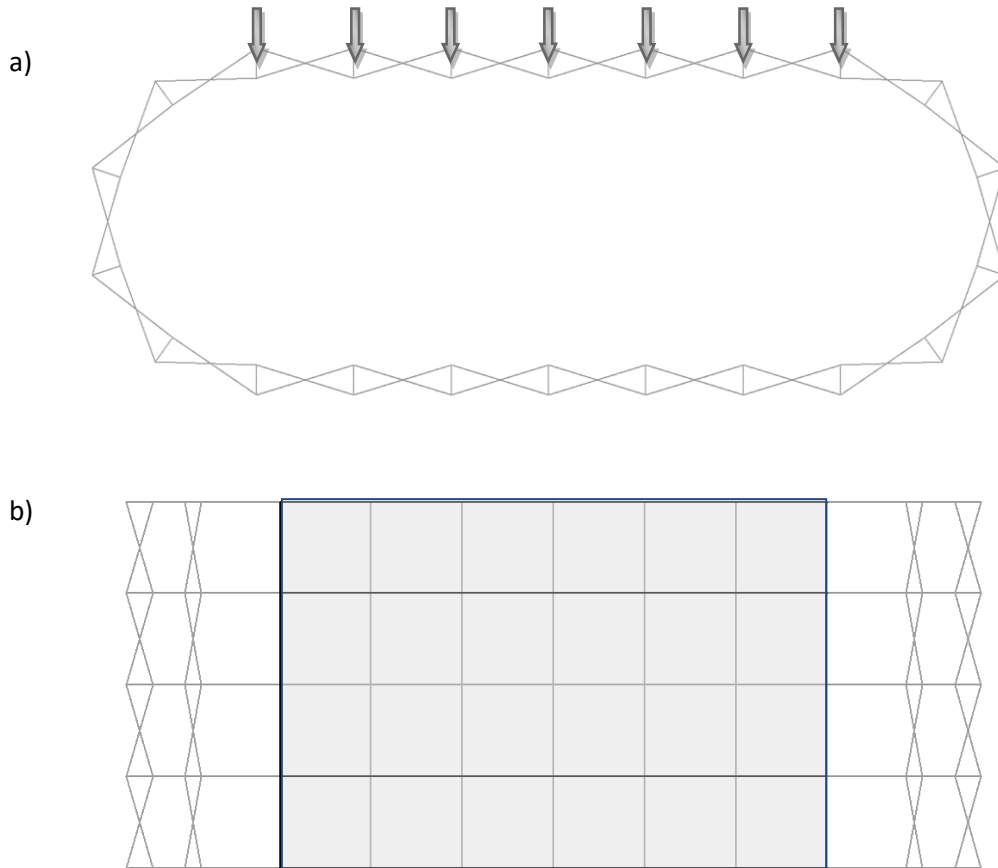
Cargas de cubierta de la estructura: a) alzado, b) planta
